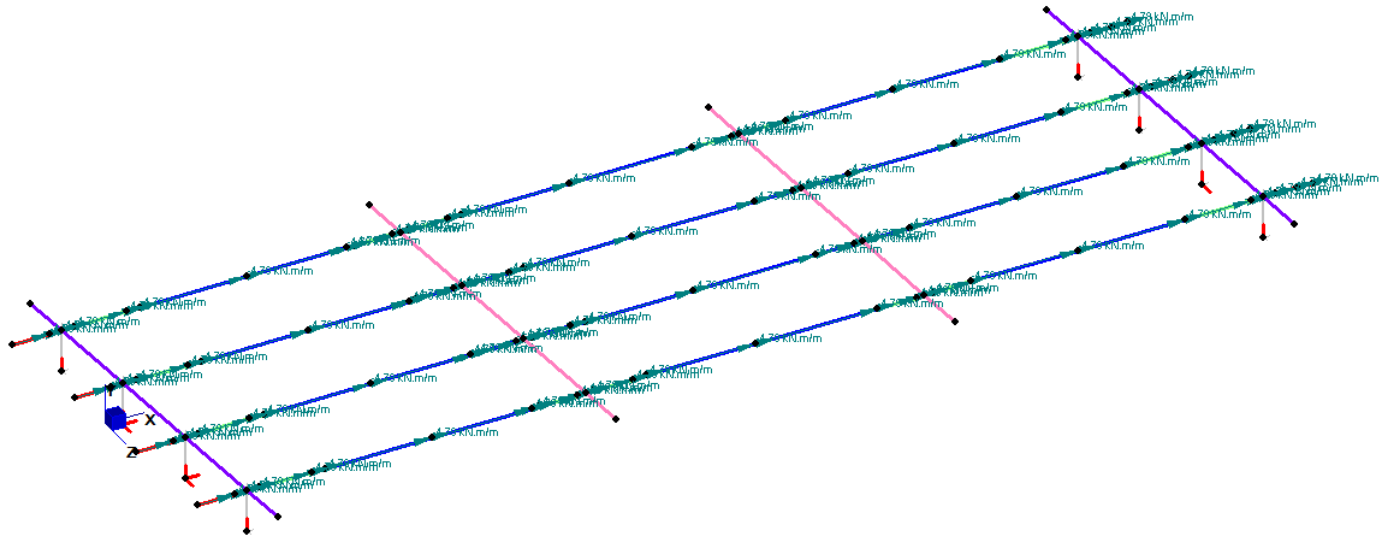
Momento dovuto all'eccentricità dell'azione centrifuga rispetto al baricentro delle travi - Carico SW/2
